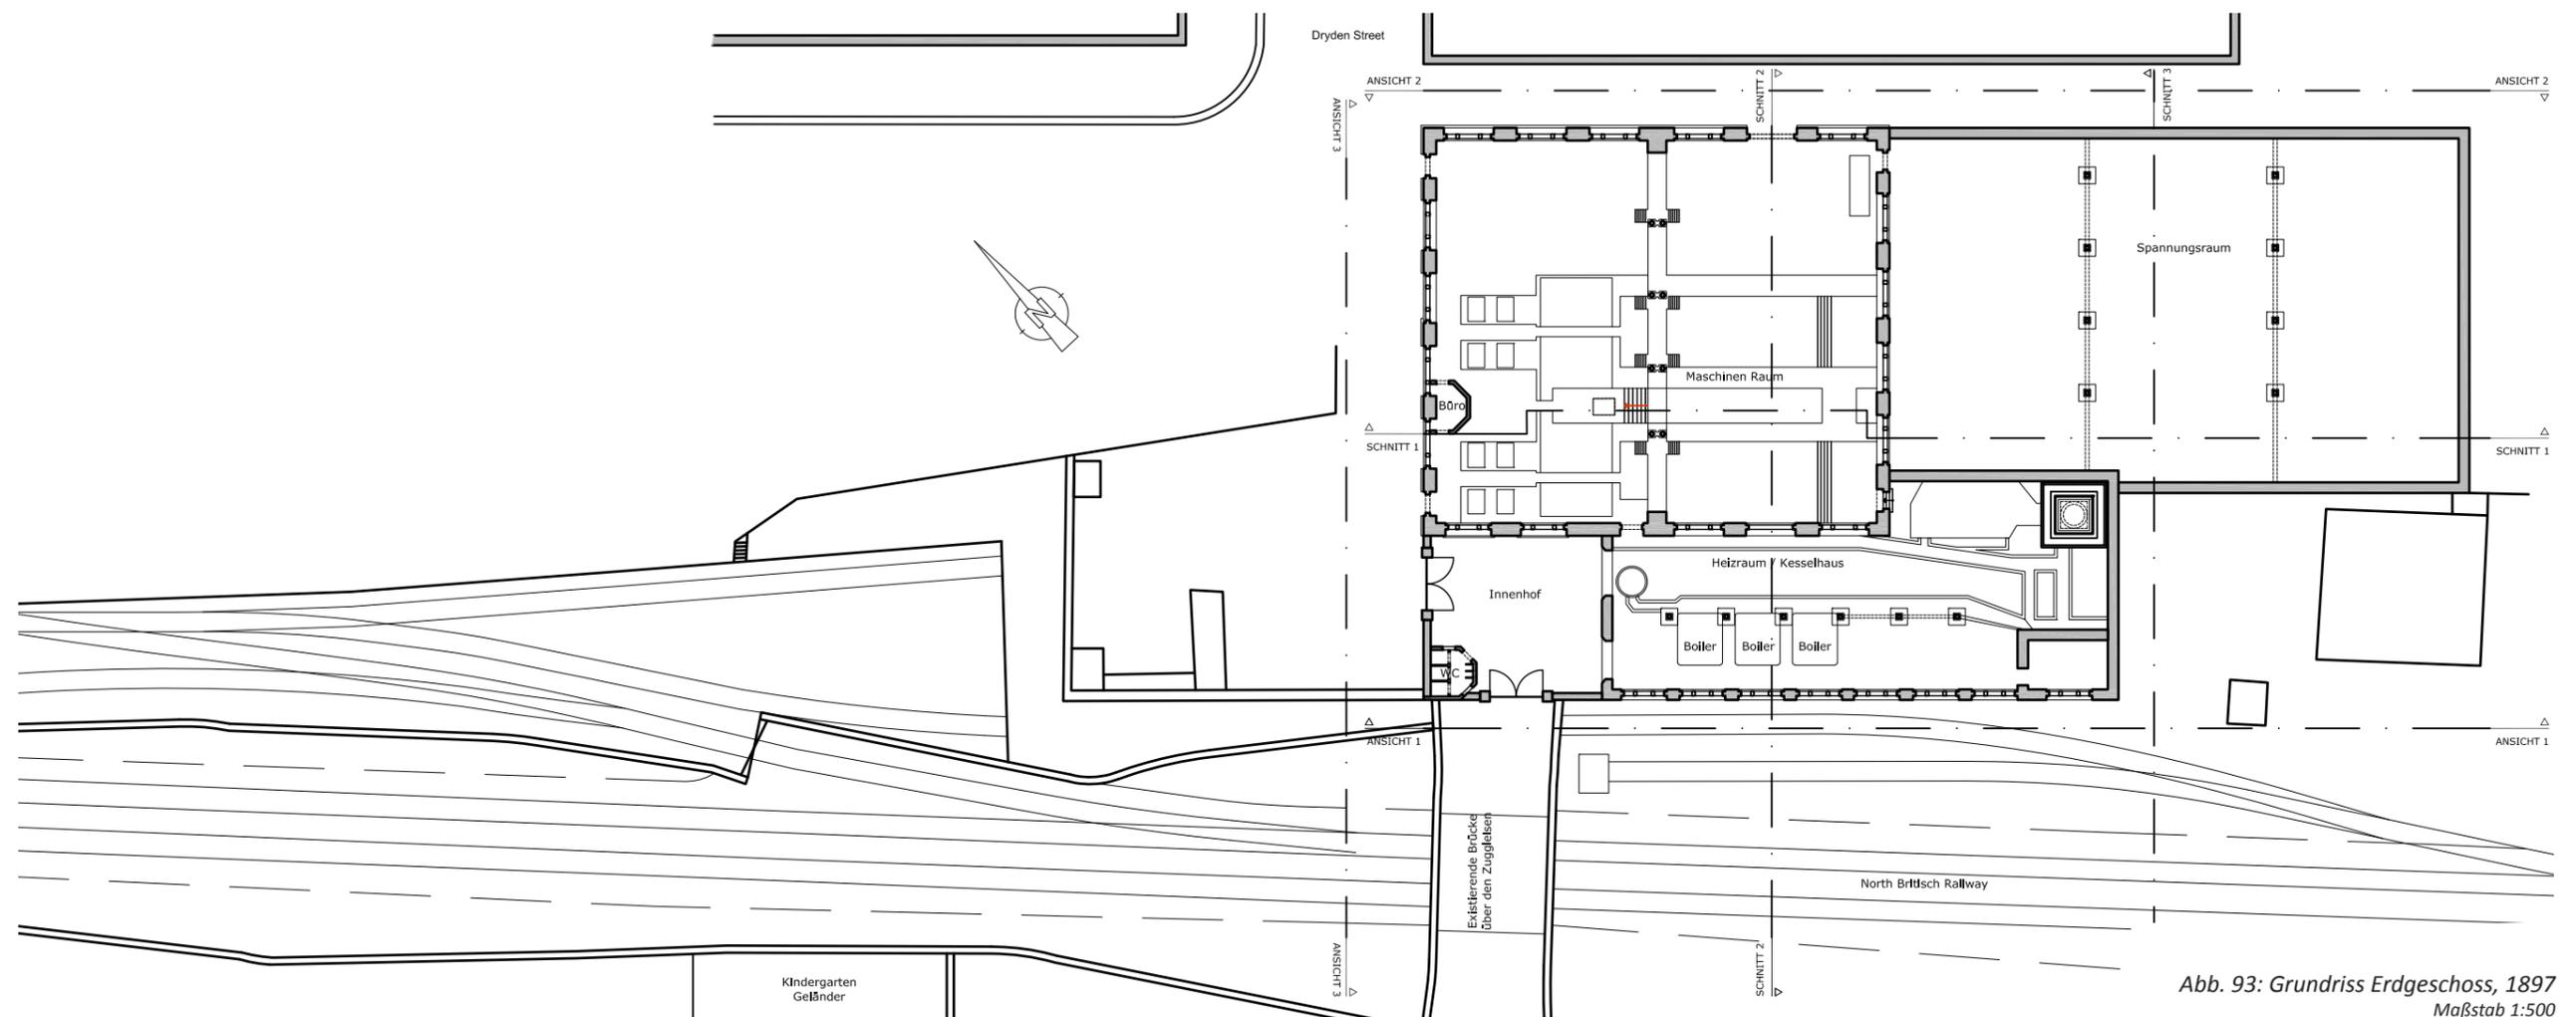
Grundriss Erdgeschoss, 1897
